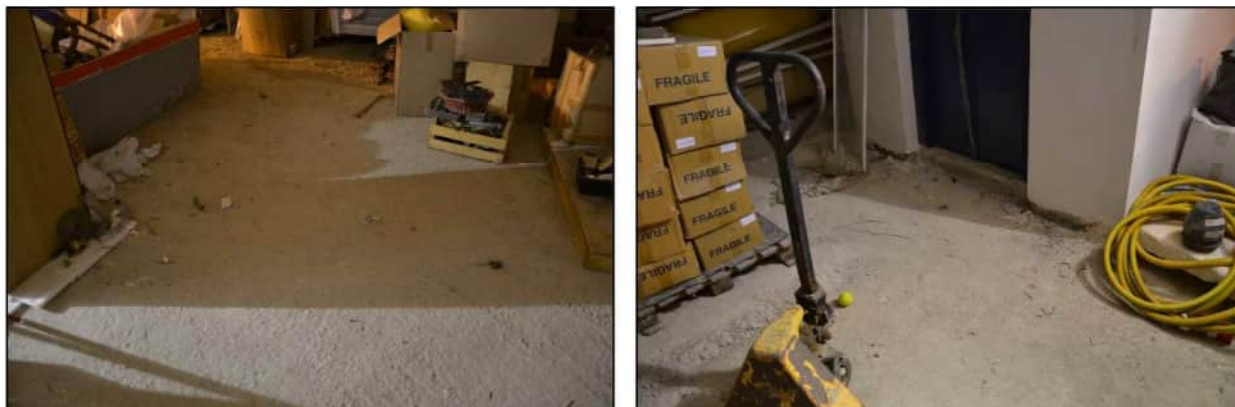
Porzione pavimento DEPOSITO 2 allo stato rustico
